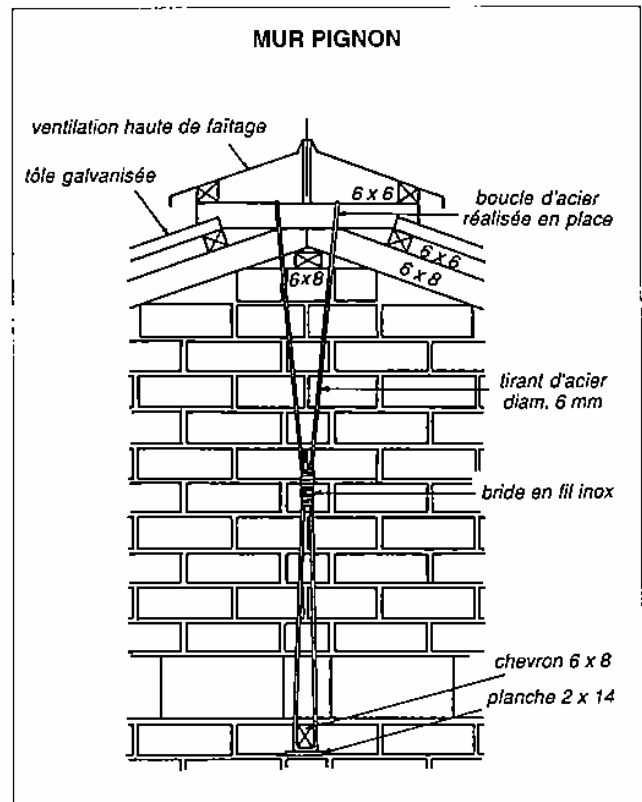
Détail sur la fixation de la ventilation de faitage en mur pignon. Le tirant métallique est bouclé sur une section de chevron traversant la maçonnerie, sous le chaînage en blocs de sable-ciment.
